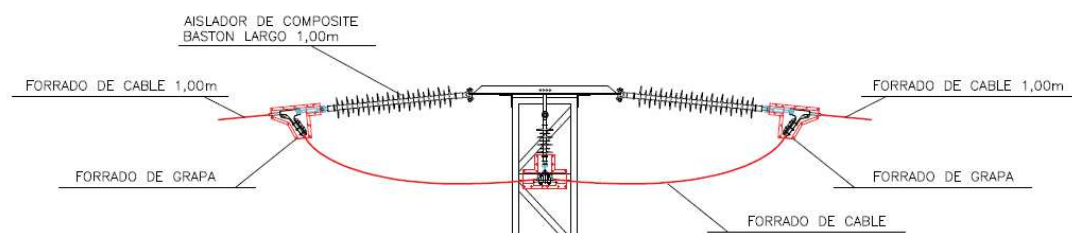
Detalle de los apoyos de nueva construcción y del aislamiento previsto.
